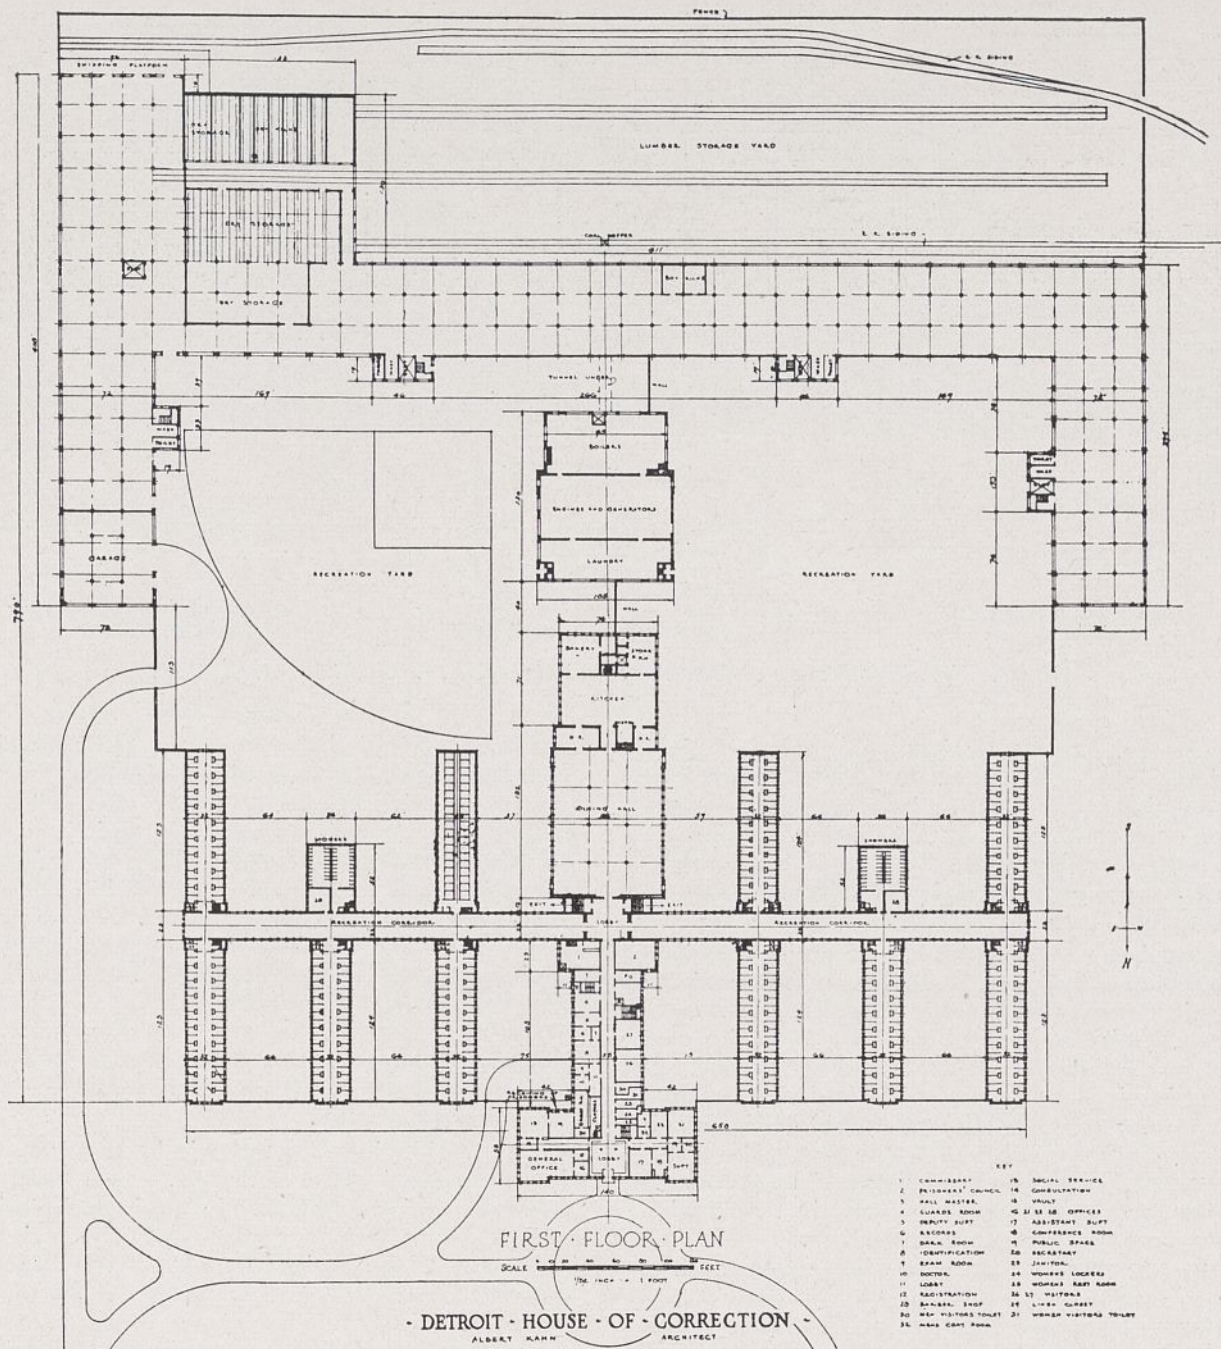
Vorschlag für das House of Correction in Detroit. Grundriß des Erdgeschosses. Architekt A. Kahn.
